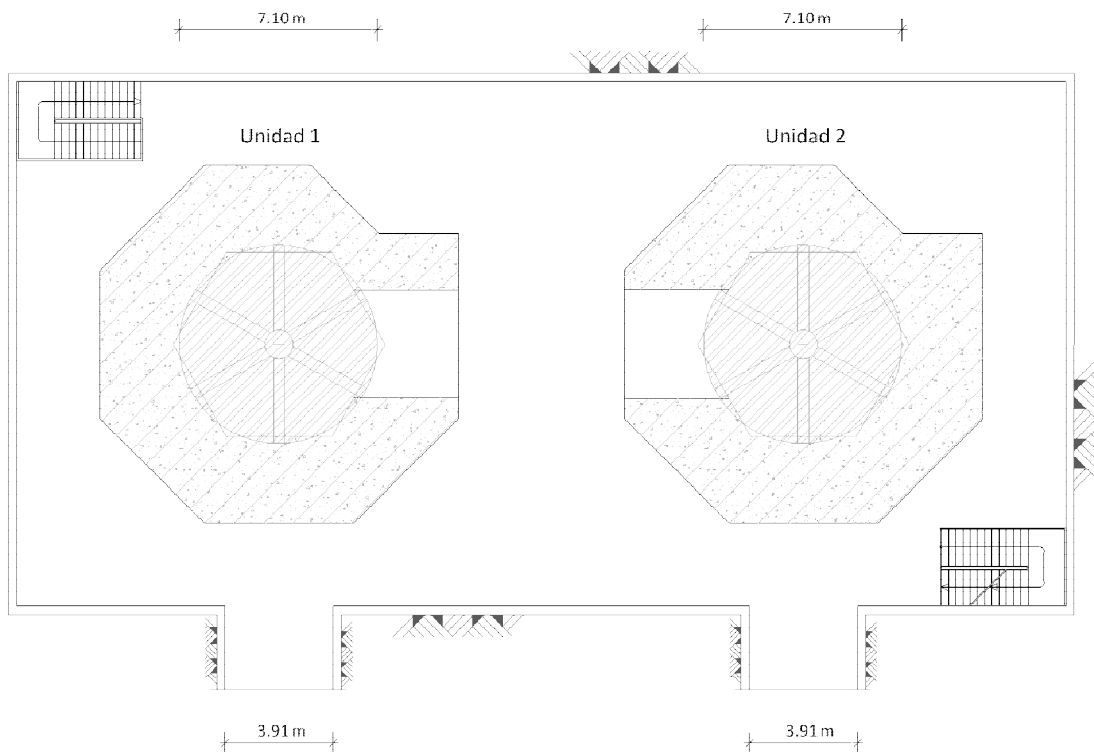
Planta piso de válvulas. Elevación 279,85 msnm
